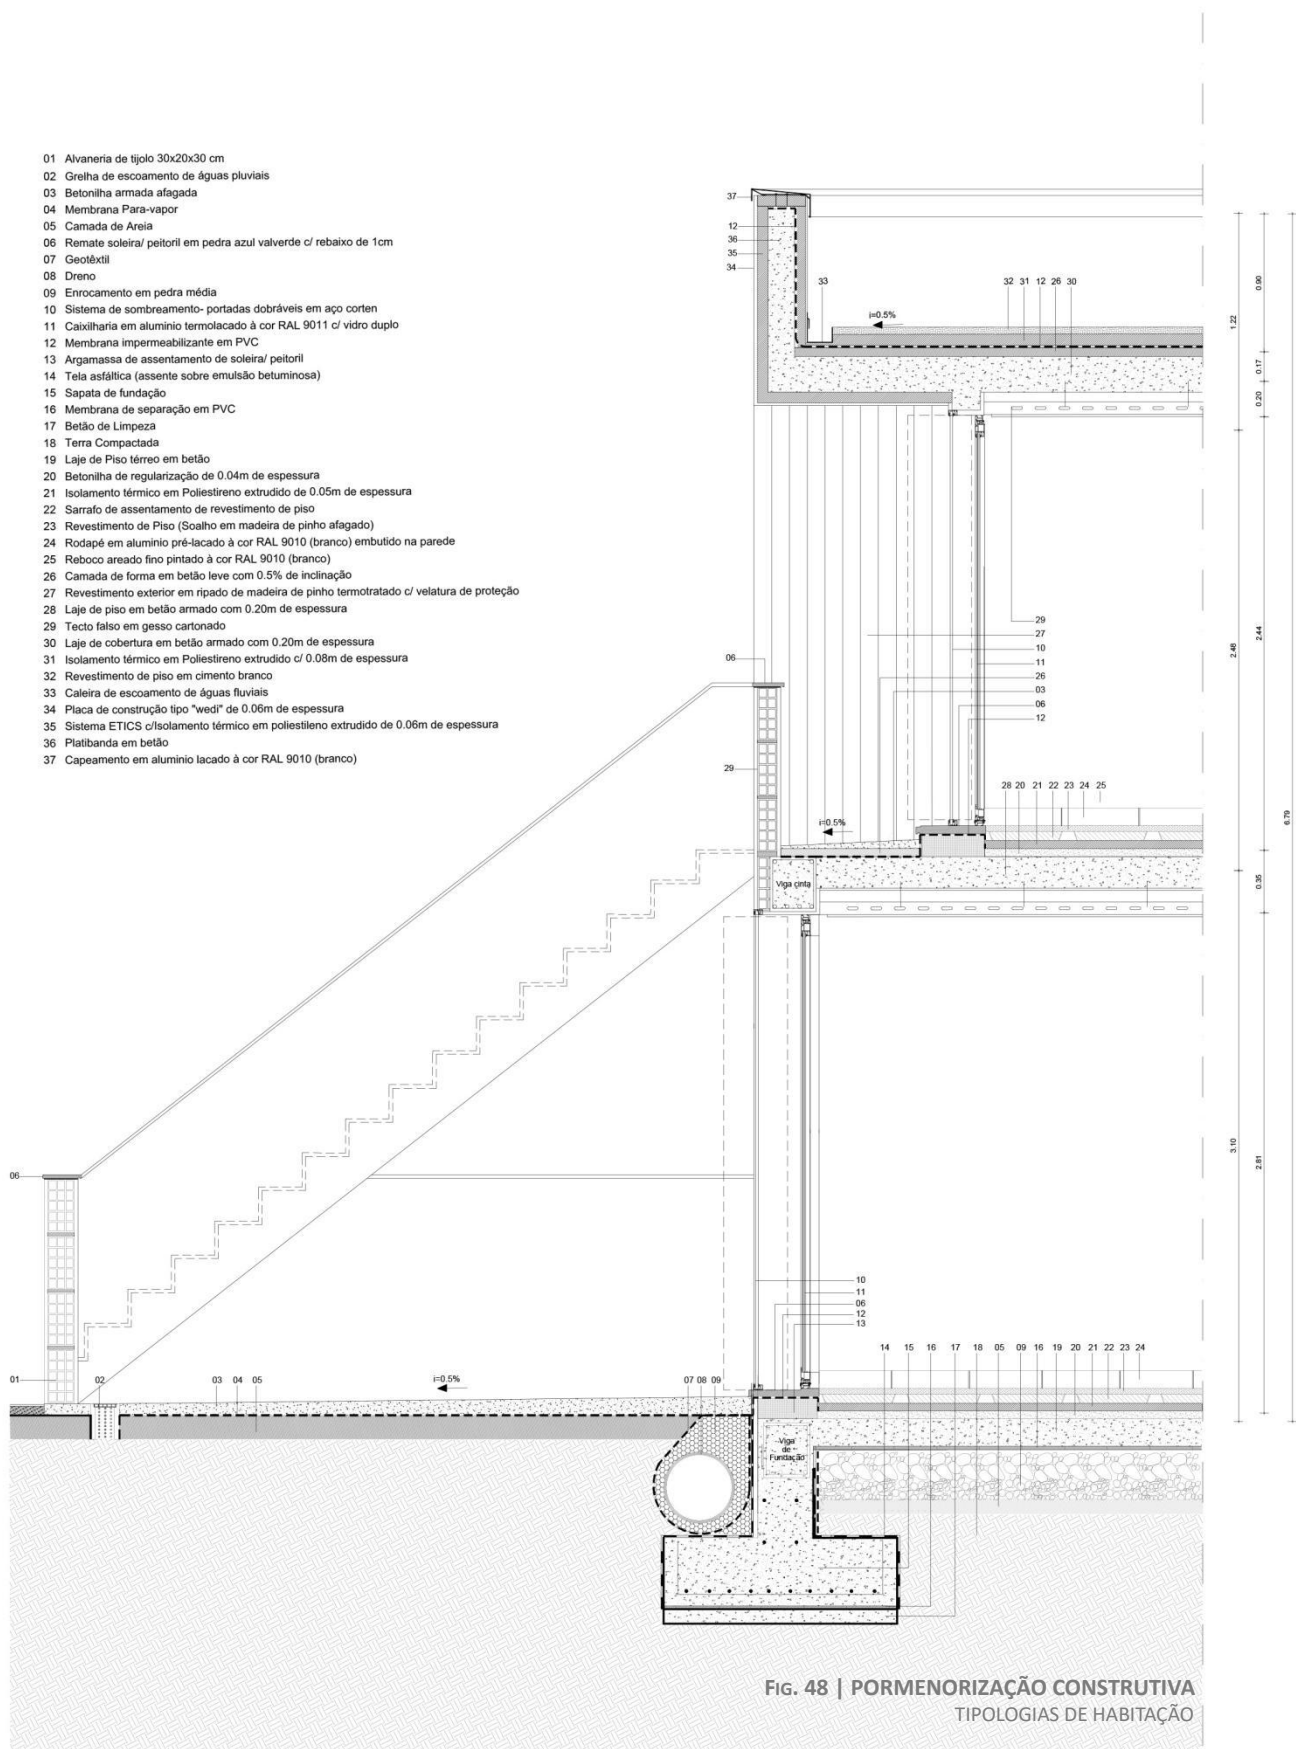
| PORMENORIZAÇÃO CONSTRUTIVA
